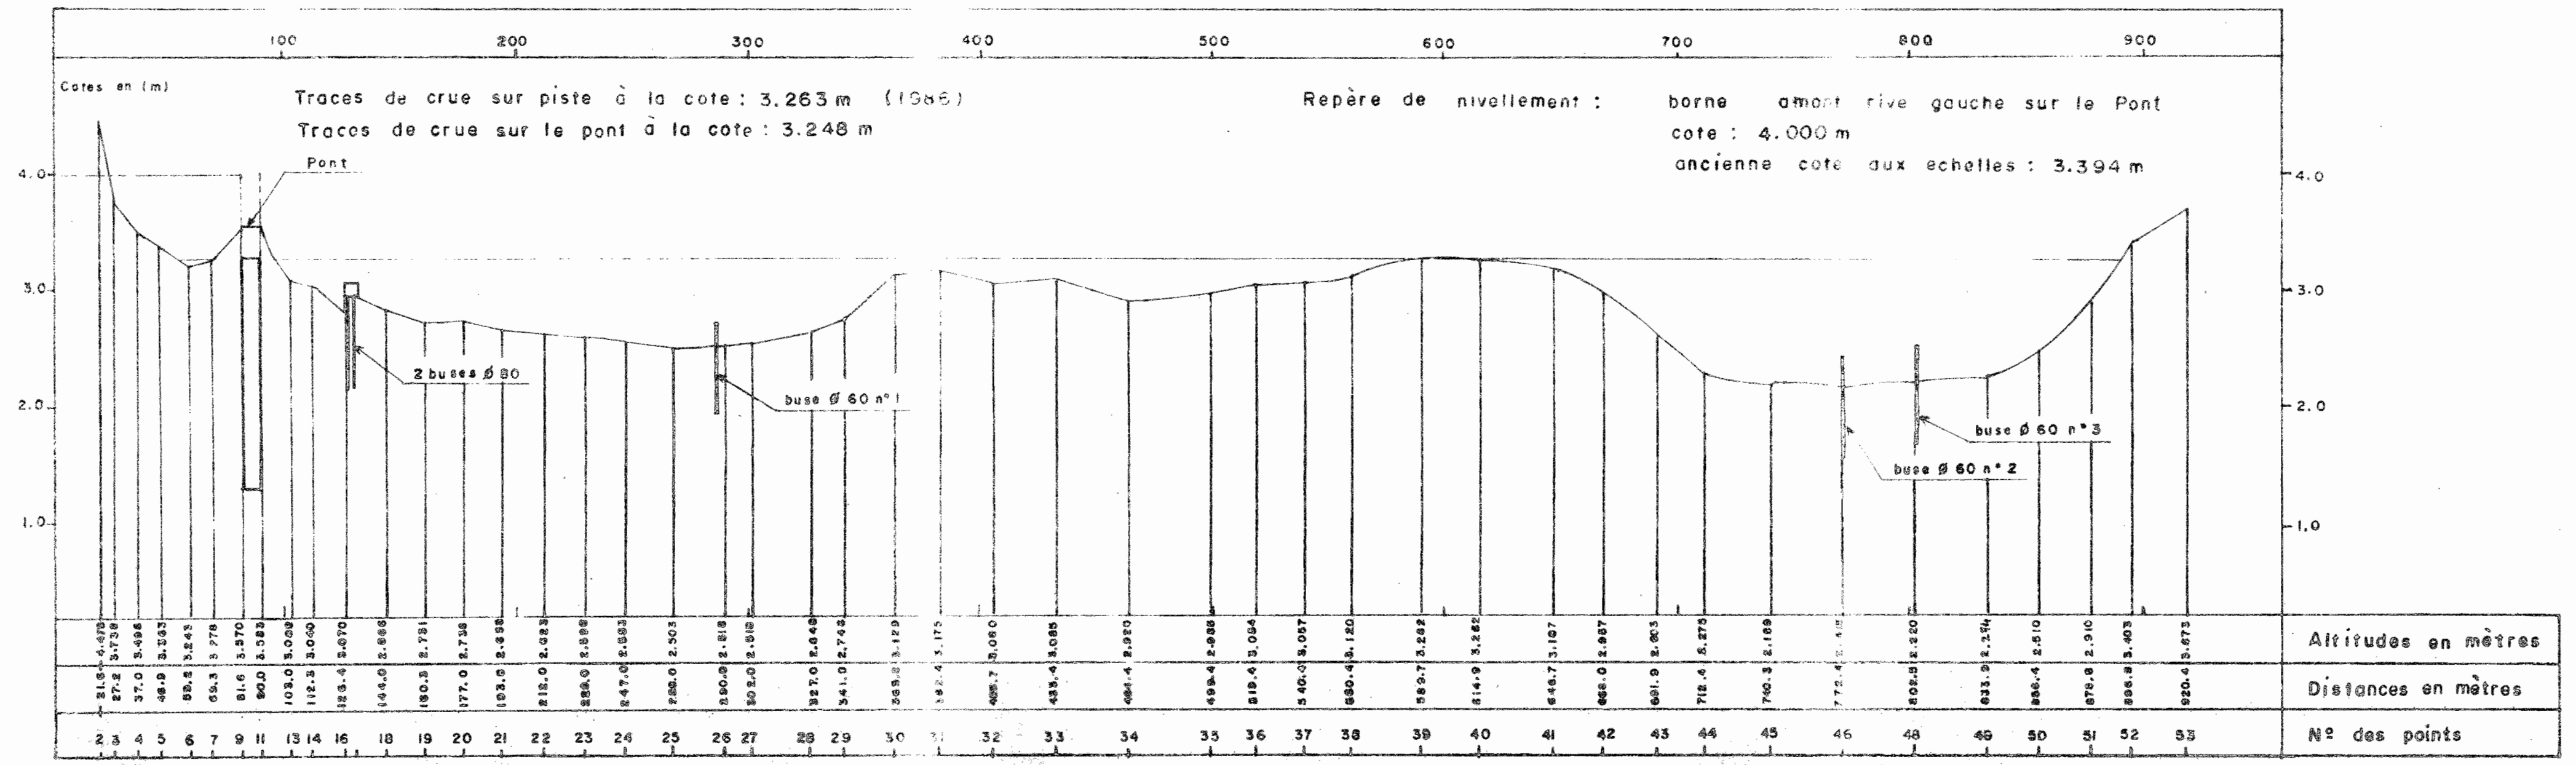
PROFIL EN TRAVERS DE LA RIVIERE BADINI A SON PASSAGE SUR LA PISTE DOUNA KONADOUGOU le 15/04/1987
